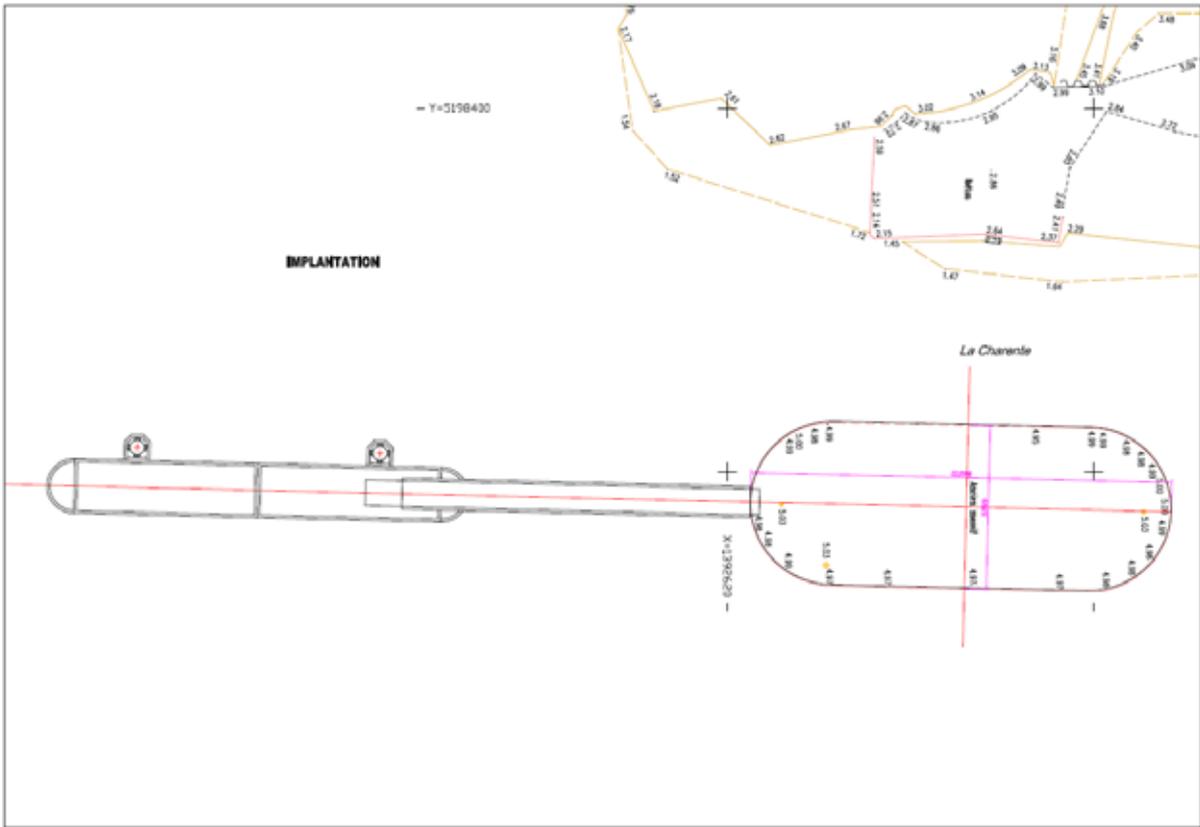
Plan en vue de dessus du ponton d'accostage rive droite - Source EGCA
